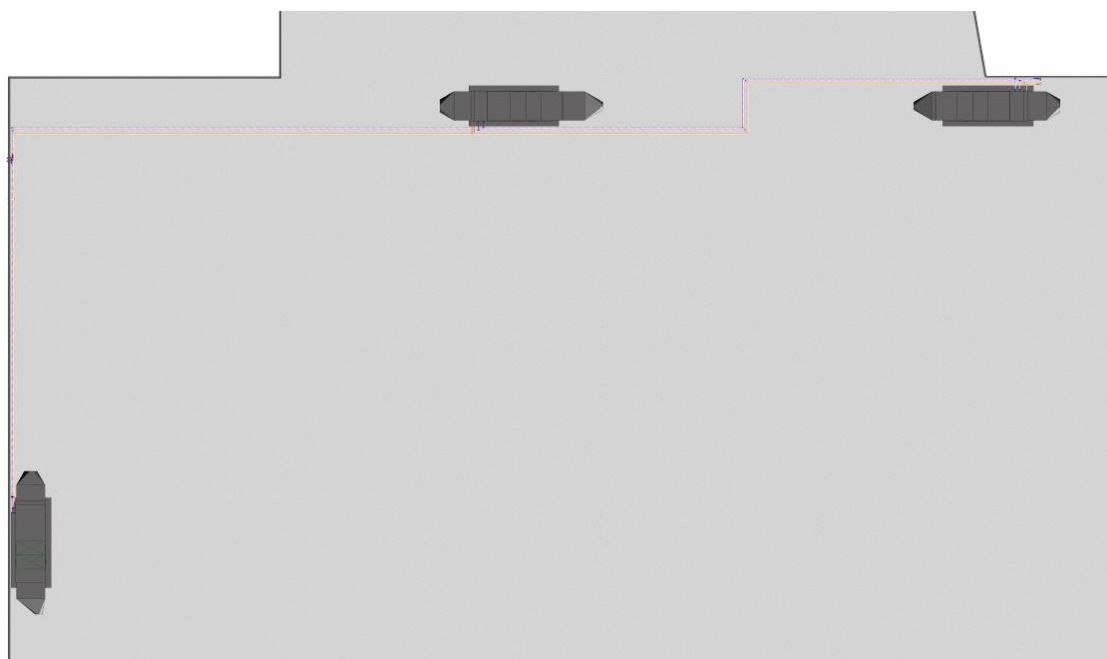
Planta com tubagem hidráulica do sistema AVAC.
